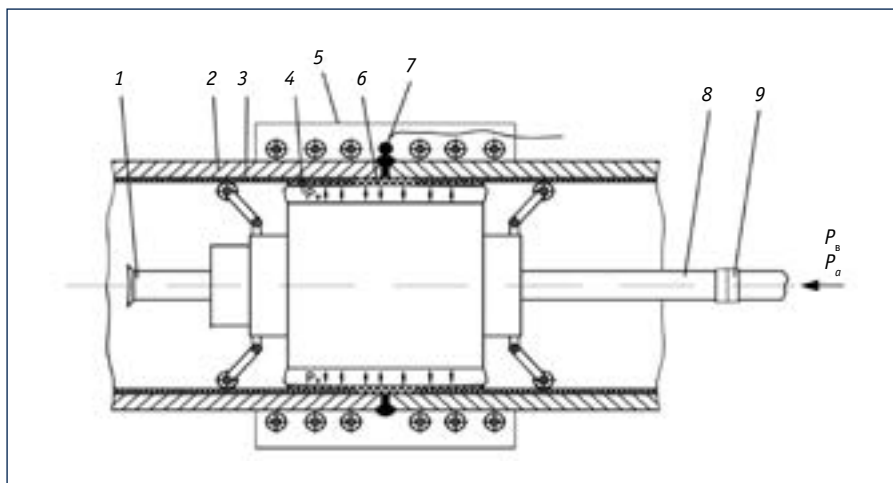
Схема внутренней изоляции бандажной лентой сварного соединения гладких концевых участков стальных элементов трубопроводов с внутренним эпоксидным покрытием:
